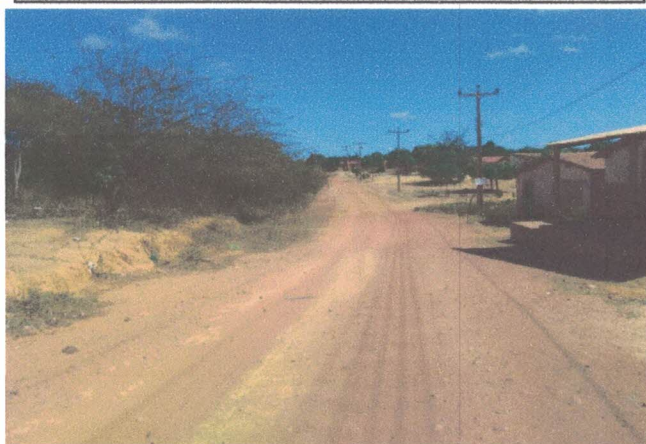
RUA PROJETADA - TRECHO 1
